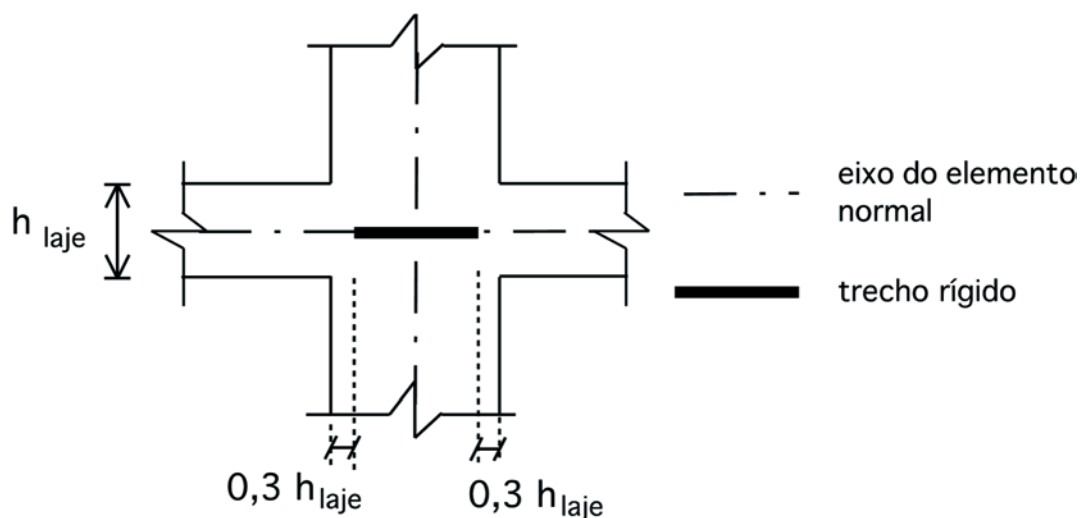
Pilar modelado analogamente a uma viga contínua (PUEL (7))
